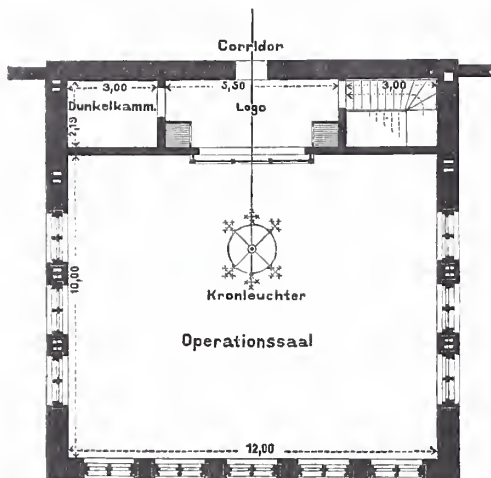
Oberer Grundriss (Schnitt a-b).
